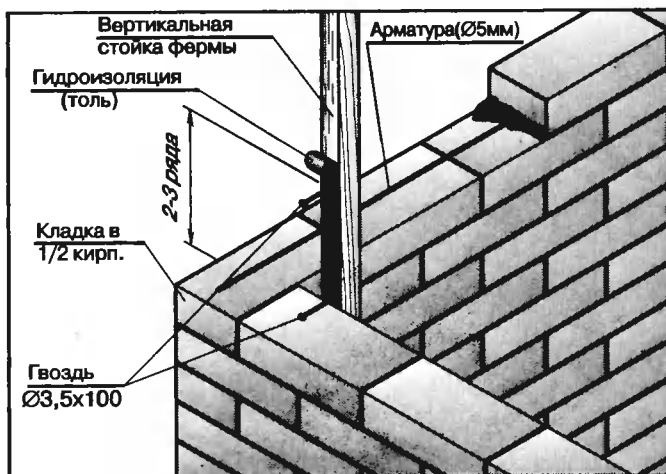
Крепление вертикальных стоек фермы со стенами в процессе кладки
